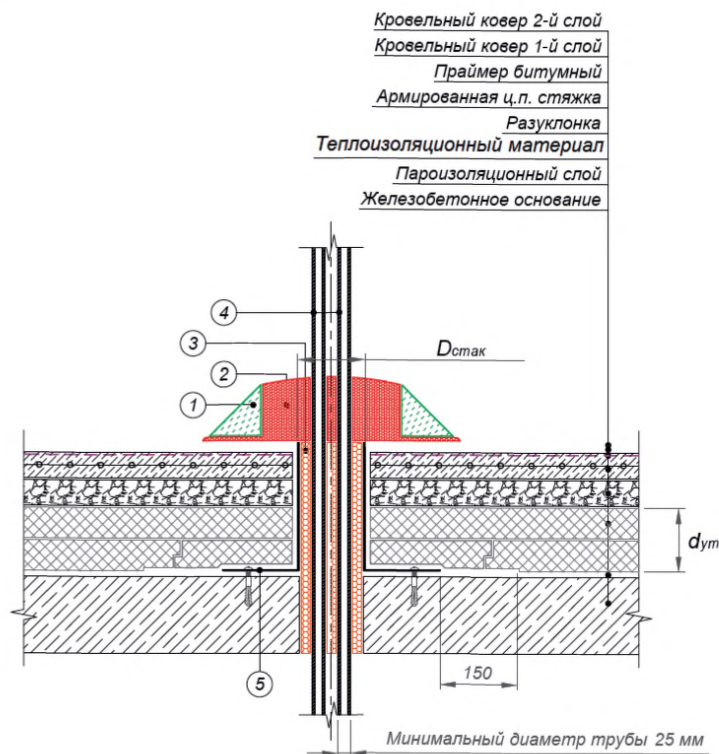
Схема пропускa электрического кабеля через совмещенное кровельное покрытие
